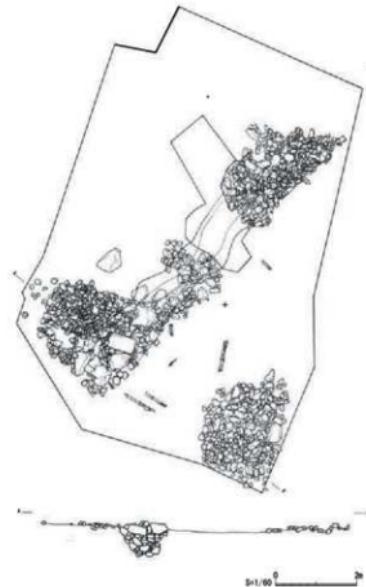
四百町開旧堤防検出石敷き遺構平面図と断面図
